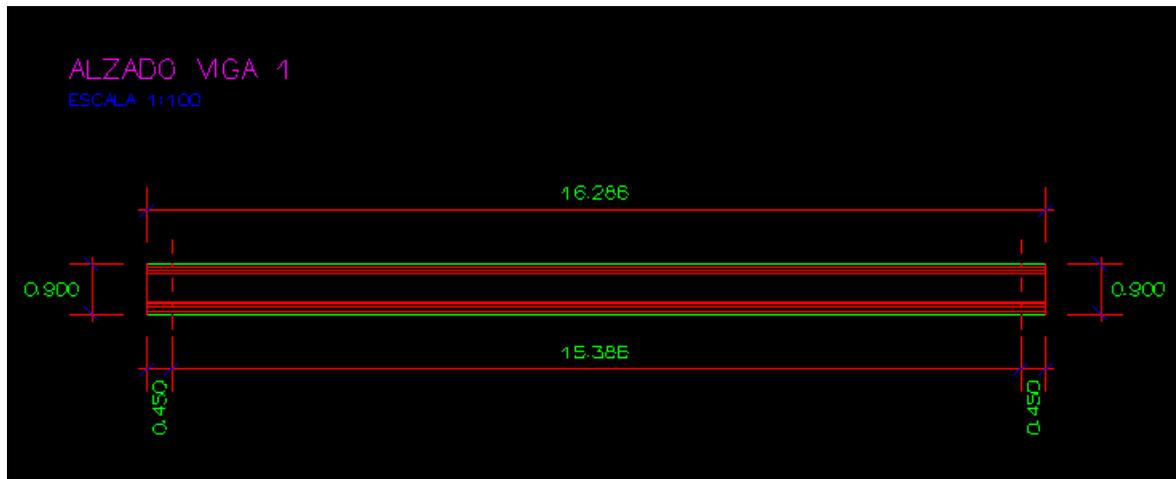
Figura *Alzado de viga*.
